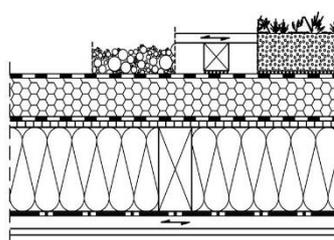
Typ II – Holzbalkenkonstruktion [3]
